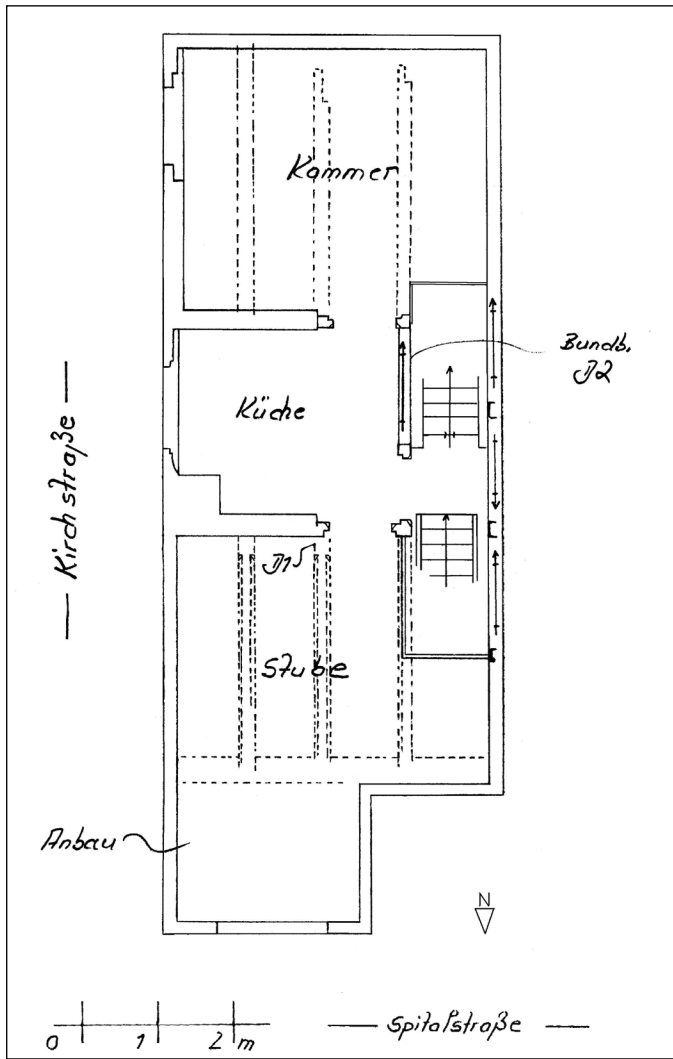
Spitalstraße 30, Grundriss 1. Obergeschoss, 1605 (d).
